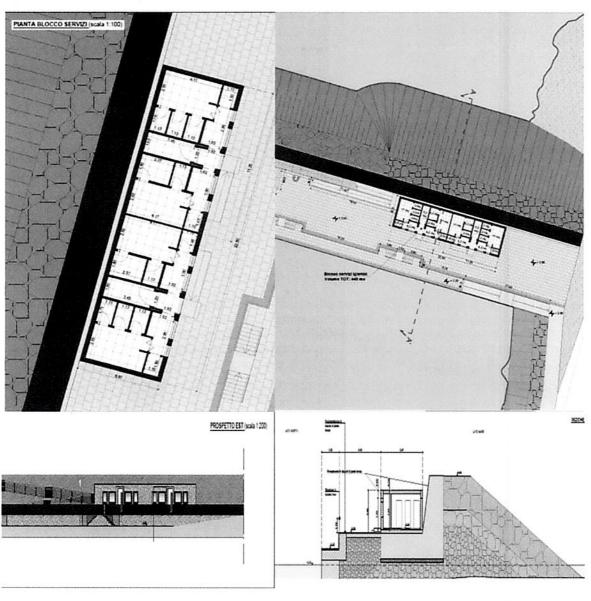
Planimetria, pianta, prospetto e sezione "Blocco servizi igienici
